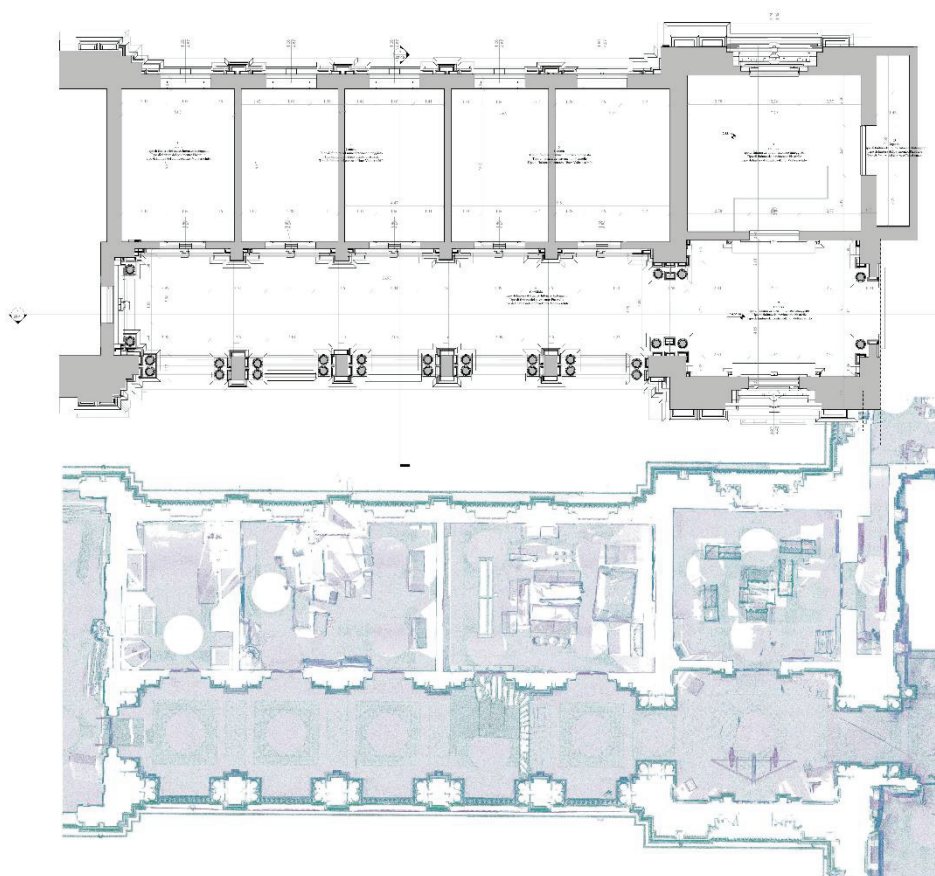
Processo de discretização da nuvem de pontos (abaixo) em modelo BIM tridimensional digital (acima). Trecho da planta do primeiro pavimento do Museu do Ipiranga, galeria leste. Sem escala.
